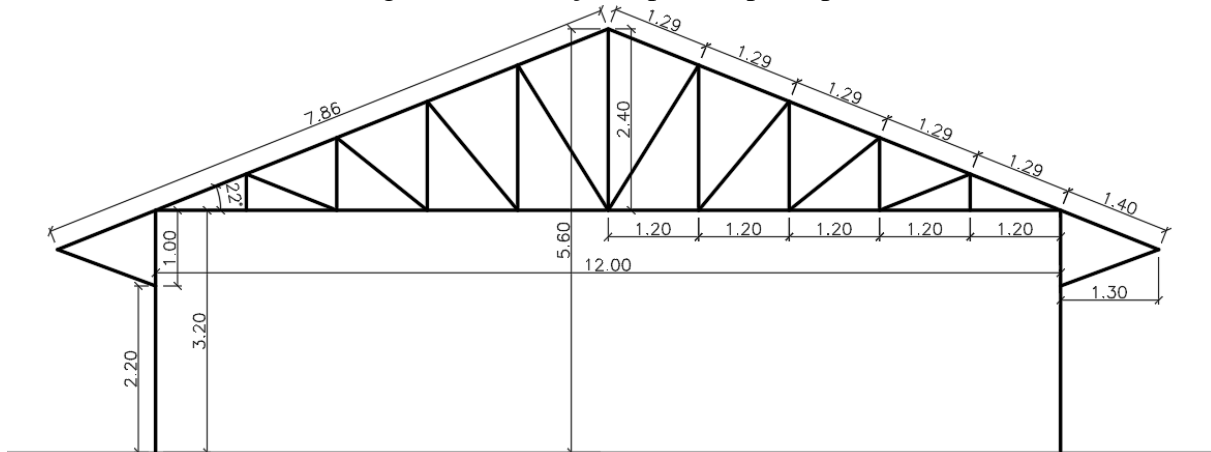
Madeiramento para instalação de telhas tipo BIG-F11.
